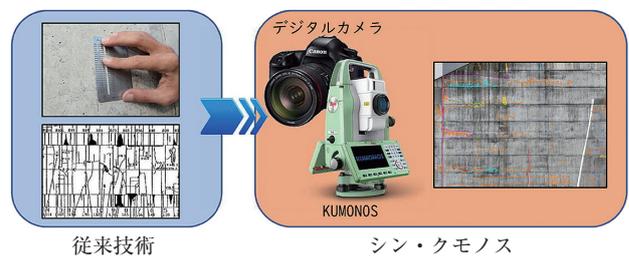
シン・クモノスによるひび割れ調査³⁾
